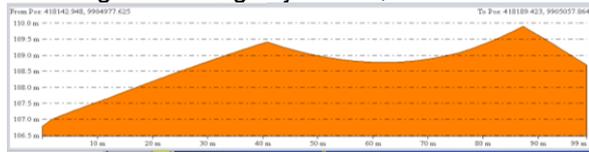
Penampang Kemiringan Jalan Tambang Pit 3E Segmen 2-3
